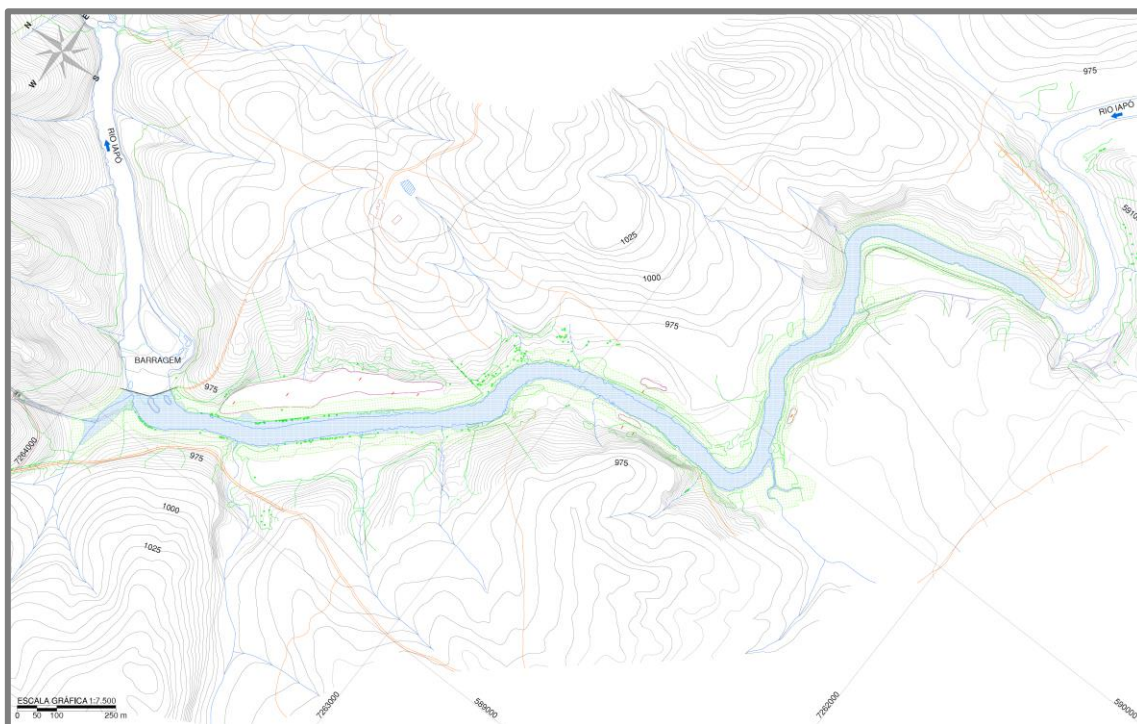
Planta do reservatório da PCH Castro El.967,00 m
